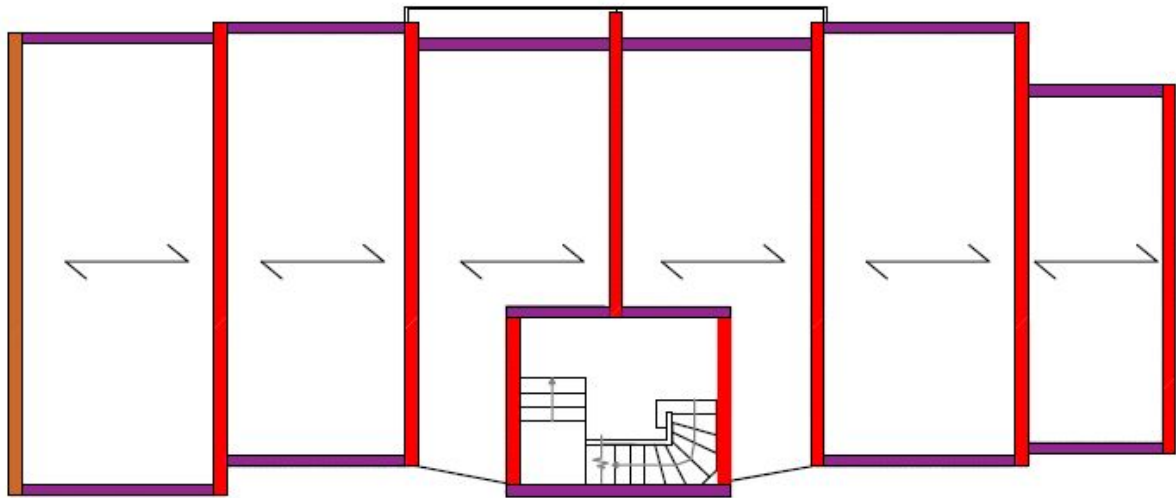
Dirección viguetas del forjado (Fuente: Anejo A)
